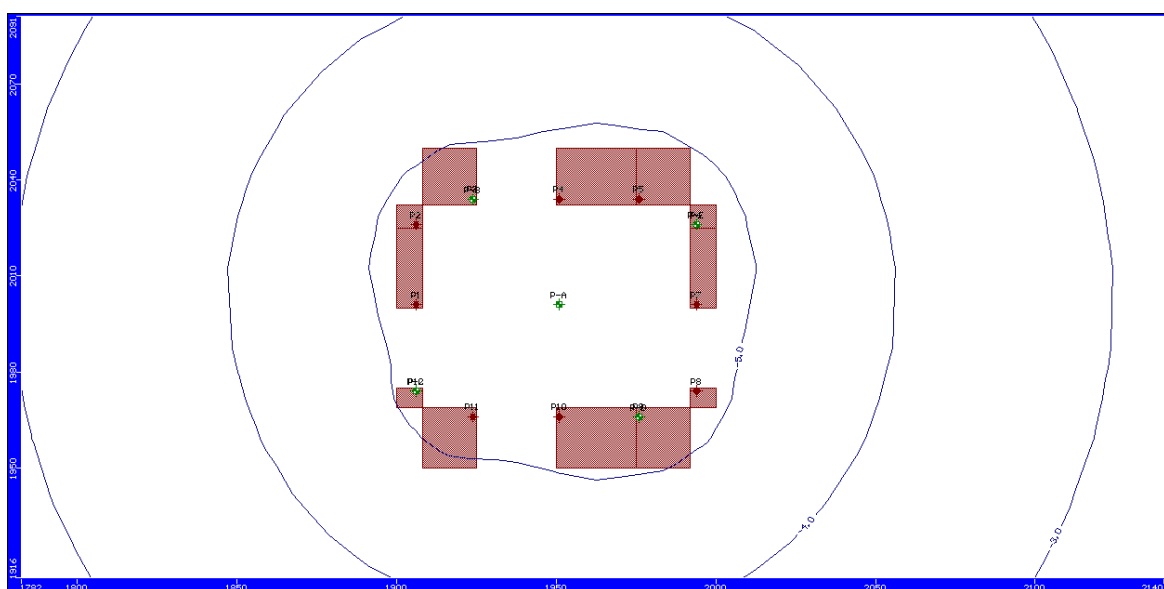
Vista en planta de la zona de excavación (capa arcillas)
